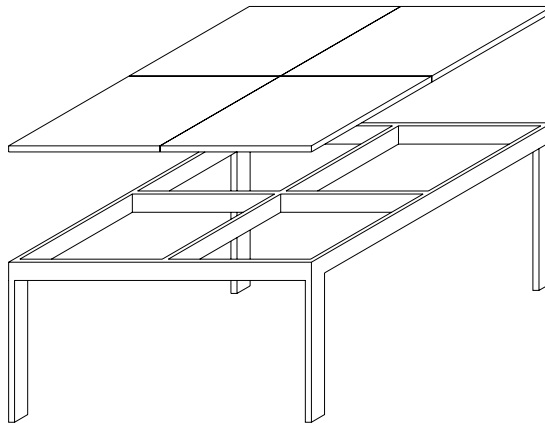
Exemplo de pavimento formado por painéis de lajes.
